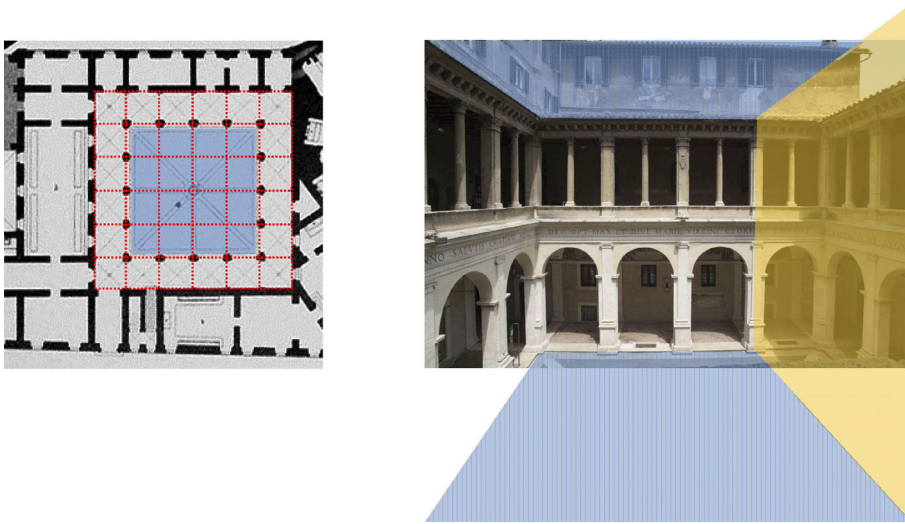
Bramante: frgamento de la planta del *chiostro* de Santa María della Pace y vista del interior del patio con fotomontaje a partir de la hipótesis de espacio cúbico según el trazado inicial de 3x3 vanos. Fuente: elaboración propia a partir de planta de Letarouilly y fotografía del autor.
